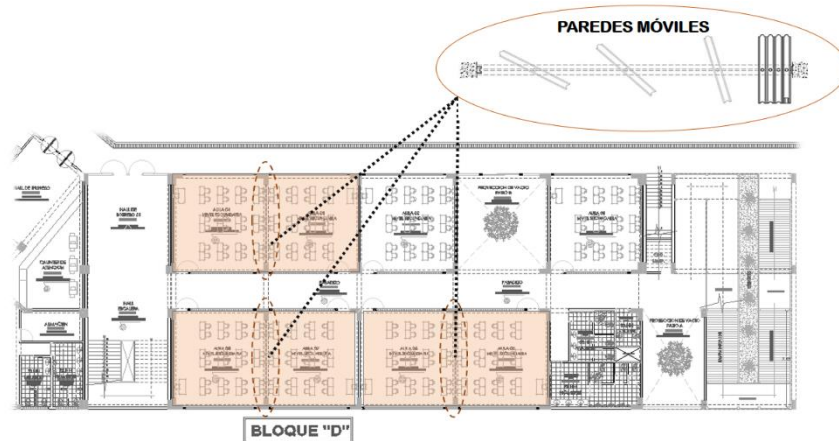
Ubicación en planta de tabiquería móvil- Bloque Academico
